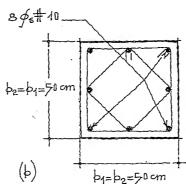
Sección trons versal de la columna vista en planta, (b).
